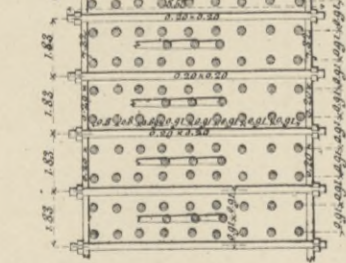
Elévation et Coupe longitudinale du mur profil type A.
